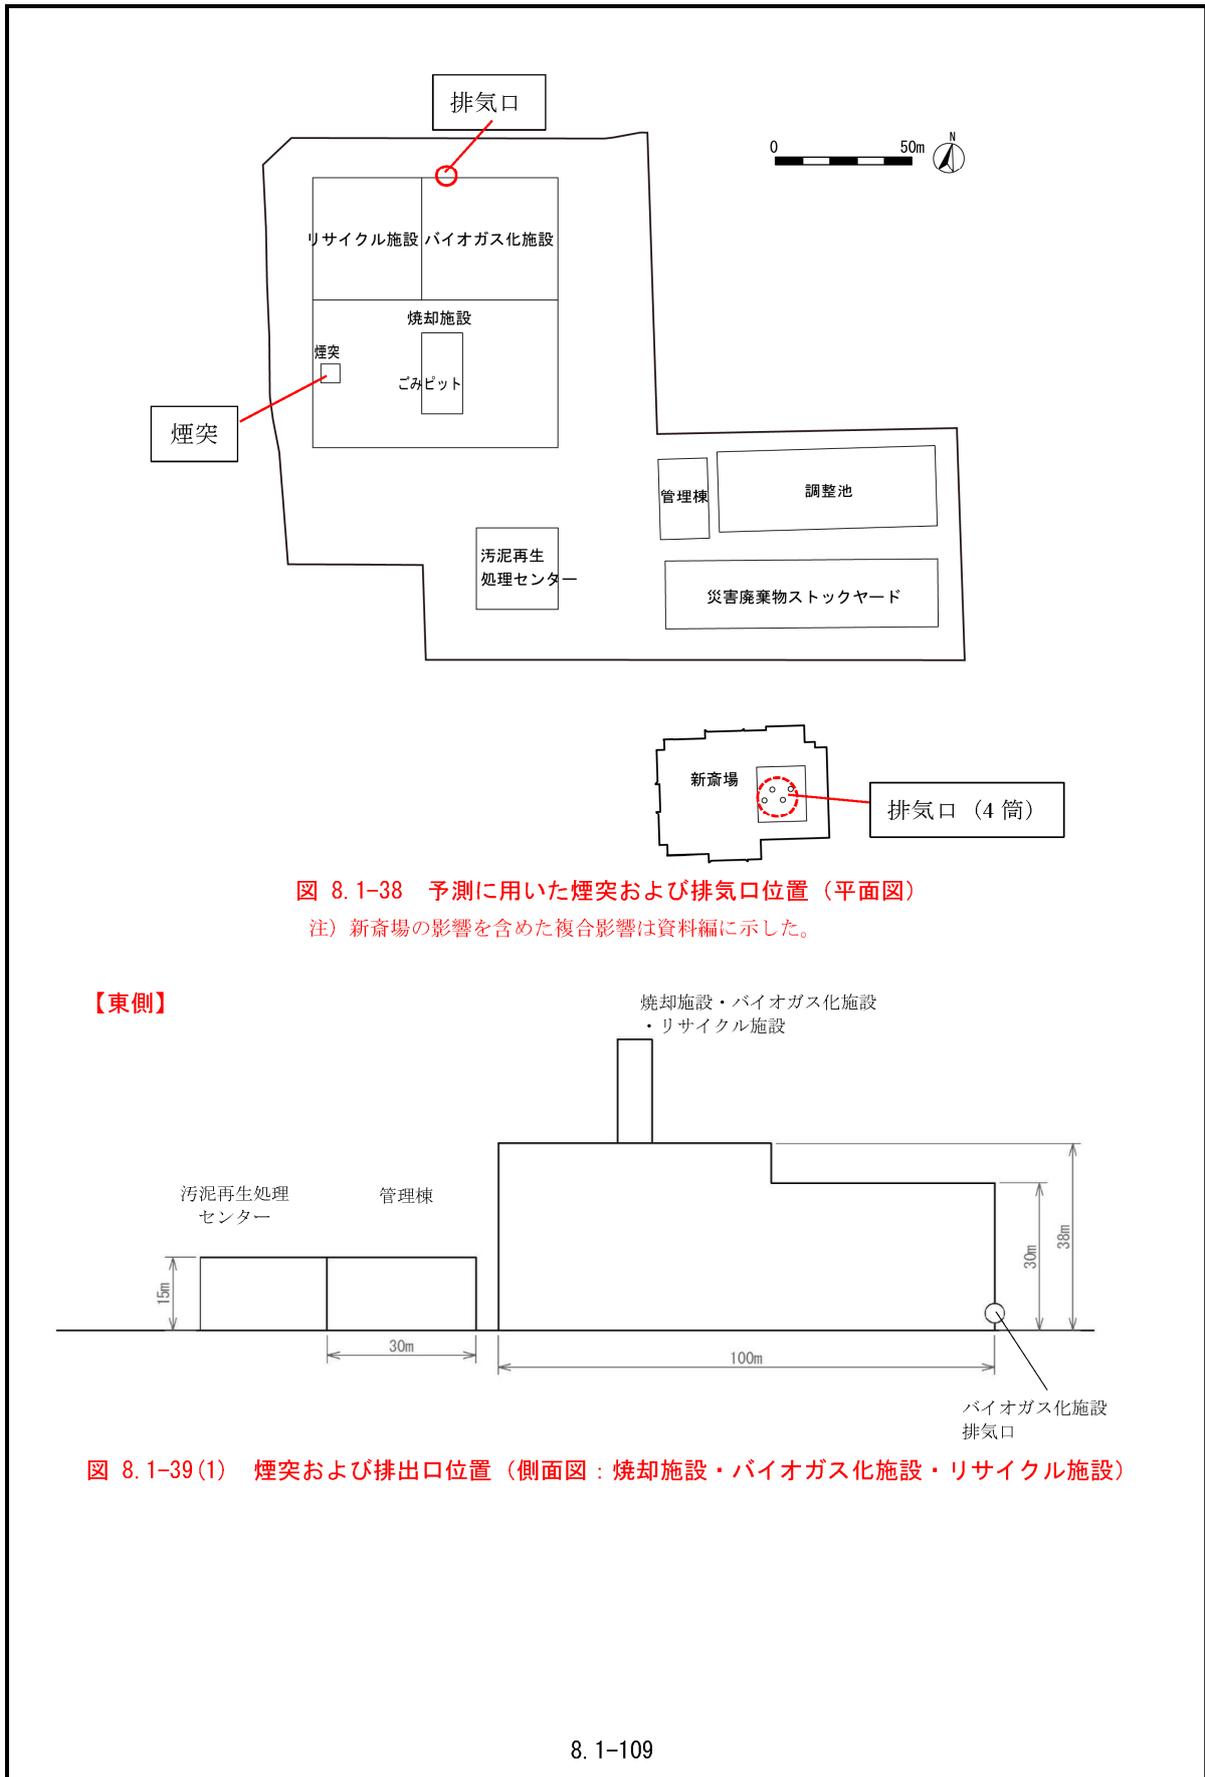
予測に用いた煙突および排気口位置 (平面図)
